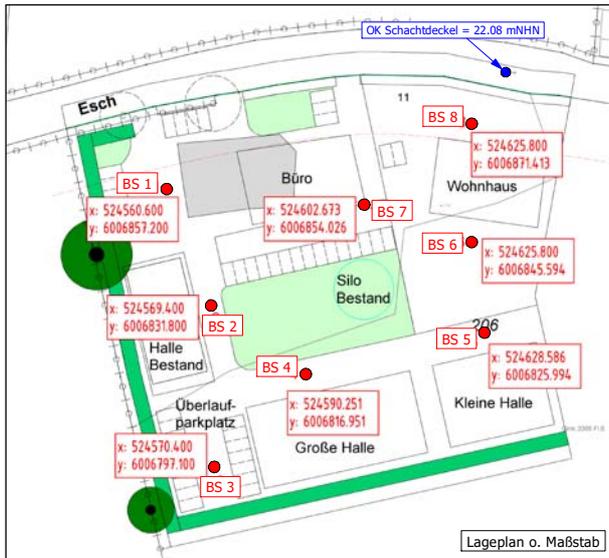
Ausschnitt Lageplan Anl. 1.1 (o. M.)
